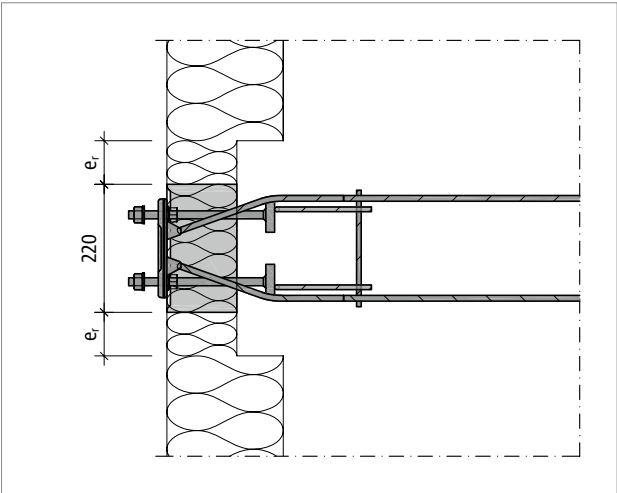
Schöck Isokorb® XT type SQ : distances aux bords
